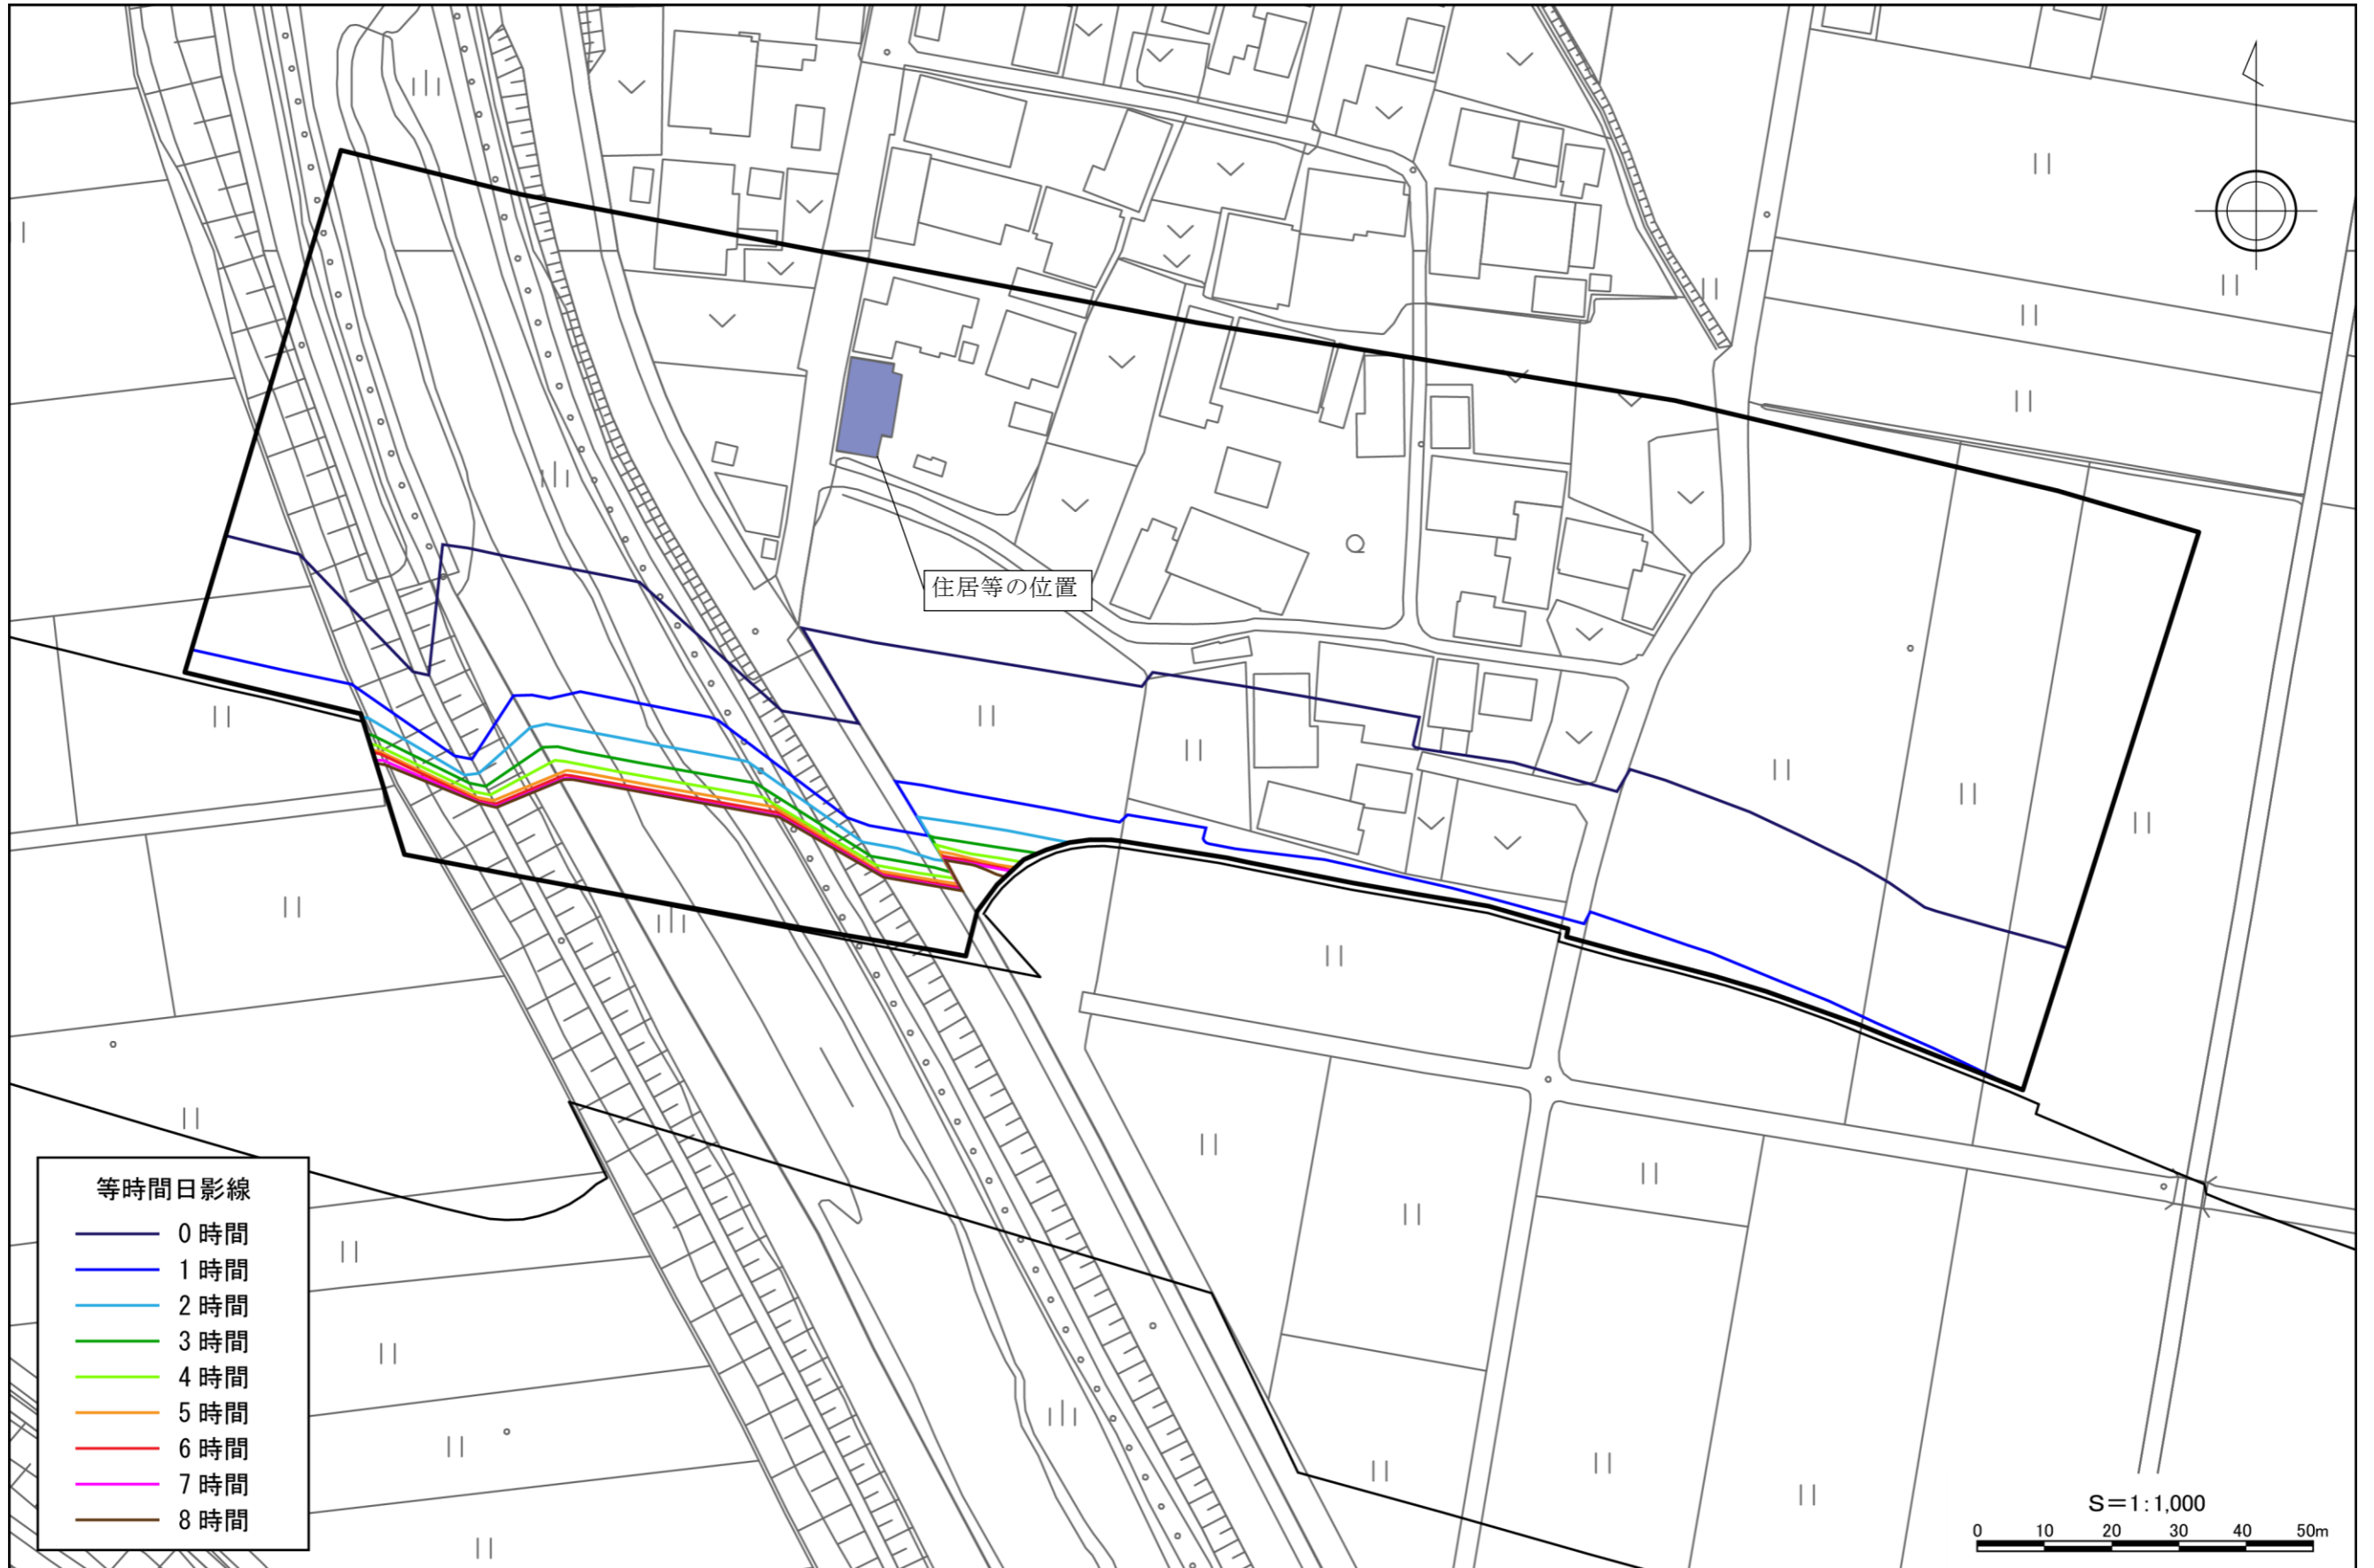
(1) 等時間日影線図 (N-1: 平面図)
